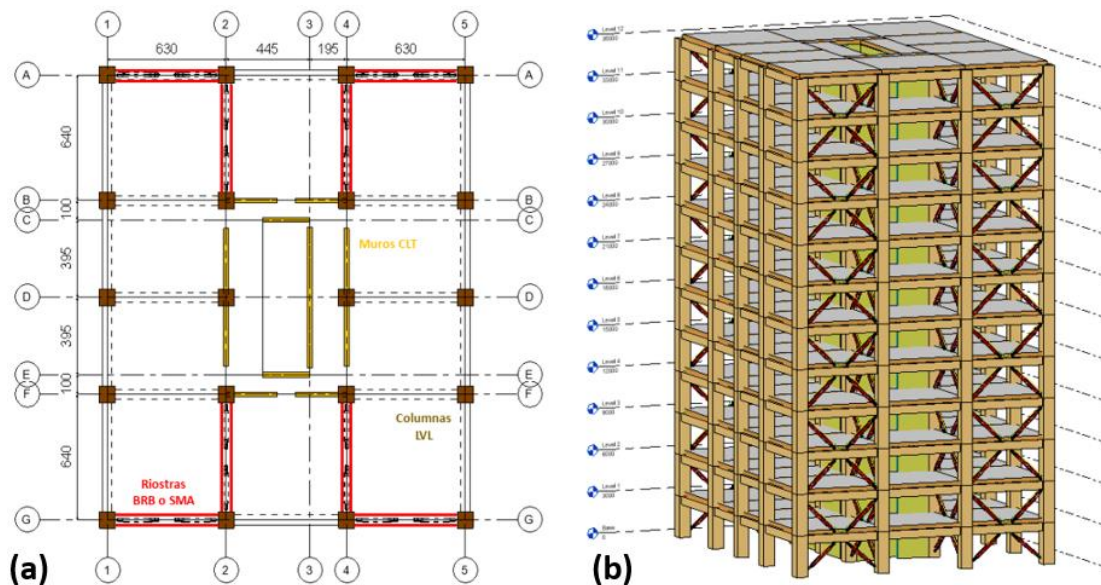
(a) Planta de la estructura y (b) vista 3d del sistema estructural [11].
